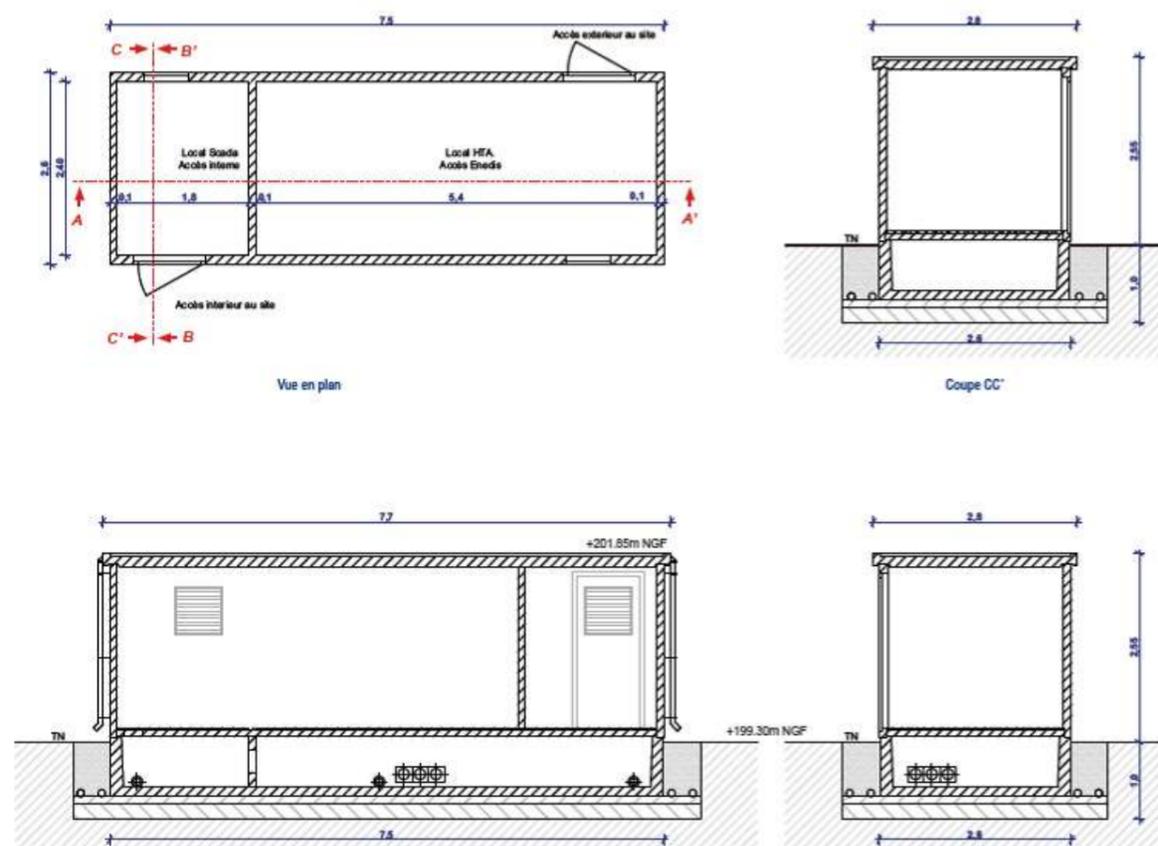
Exemple d'un schéma d'un poste de livraison (Source : EDF Renouvelables)
